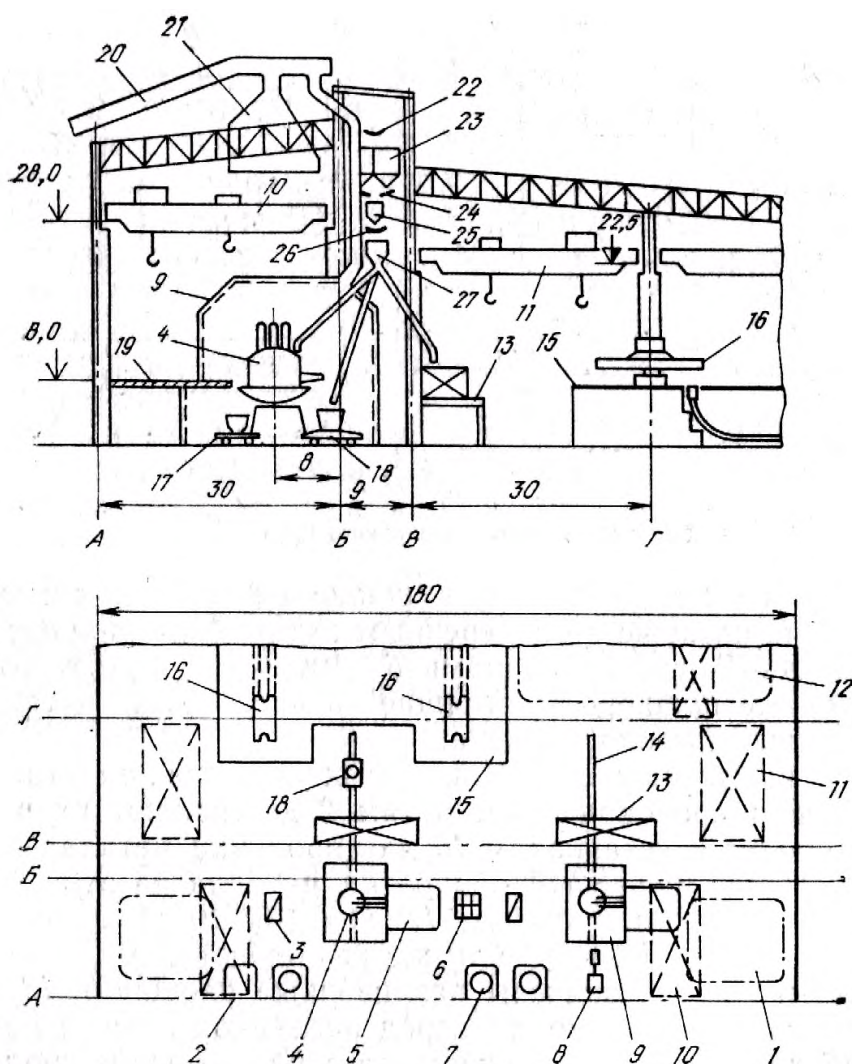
План и поперечный разрез электросталеплавильного цеха Д
